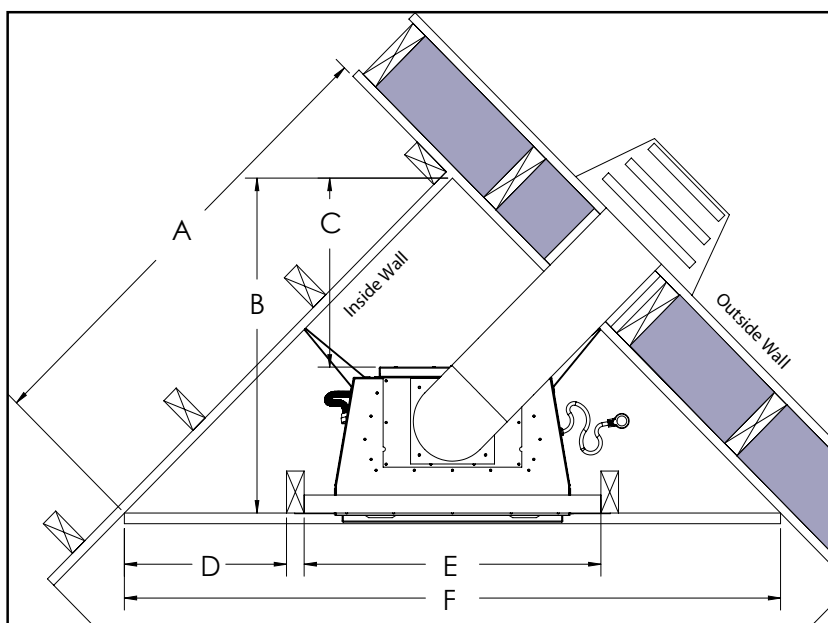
Dimensions pour une installation en coin, en haut évacués.
